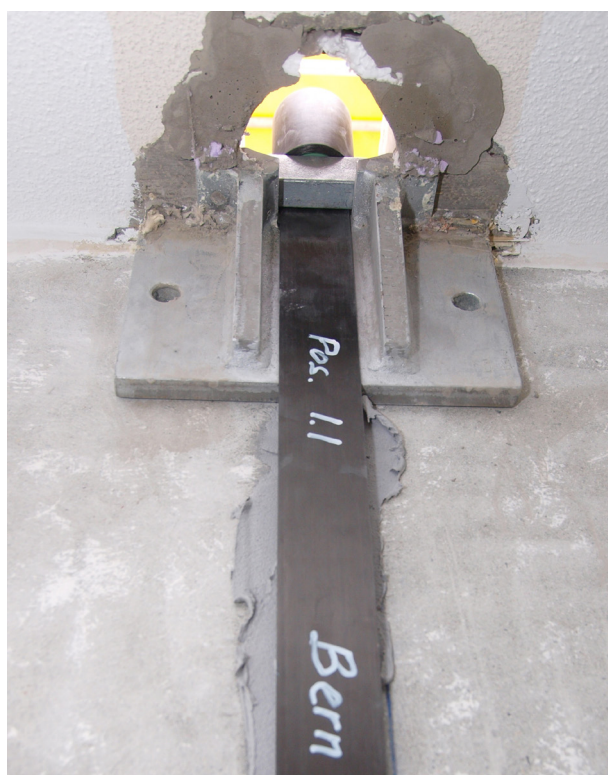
Ansicht Verankerung Dachgeschoss und CFK-Lamelle Sika CarboDur S626 mit Sikadur 30 verklebt.
